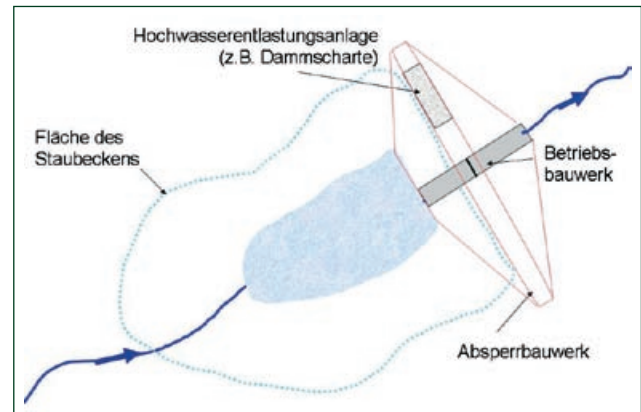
Prinzipskizze eines HRB bzw. einer TSP im Hauptschluss mit Dauerstau (Lageplan)
